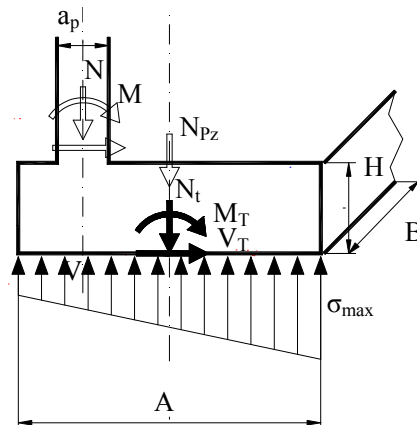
Zapata Aislada. Modelo lineal de tensiones (Caso 1).
